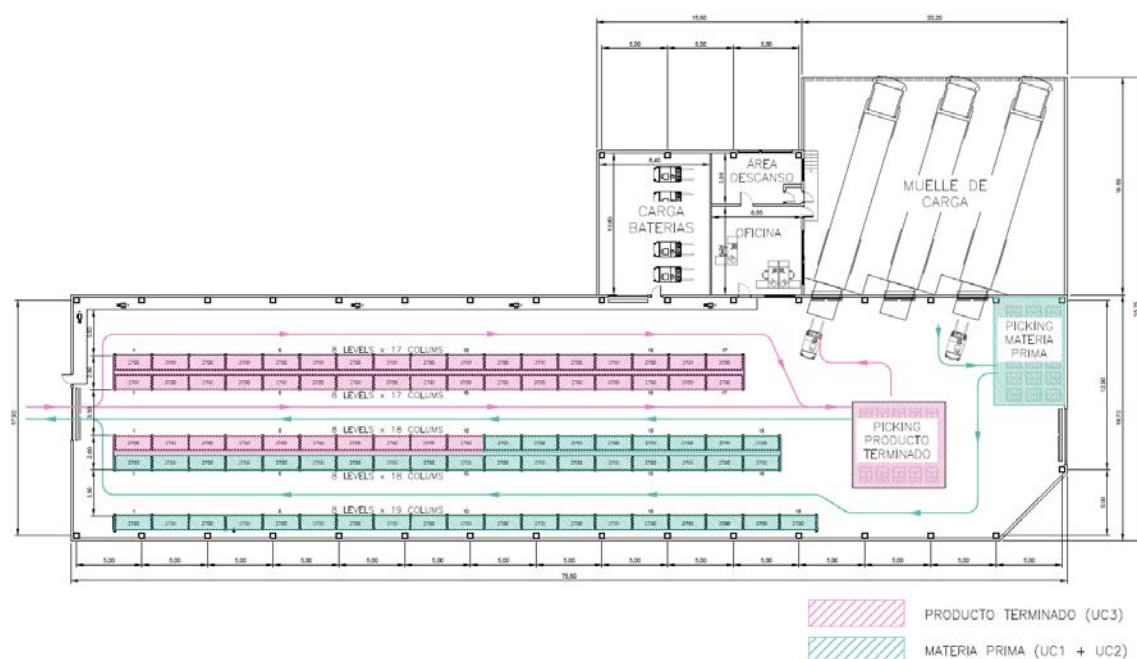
Planta y distribución de espacios del nuevo almacenamiento
